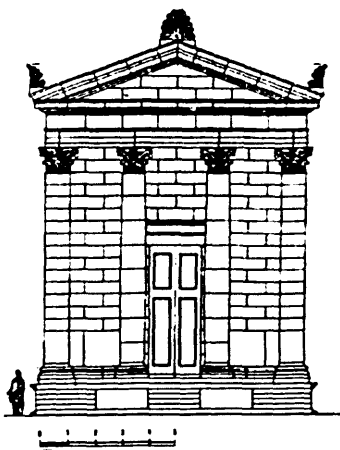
Aleria: élévation du temple de l'est du Forum d'après Pierre André.
